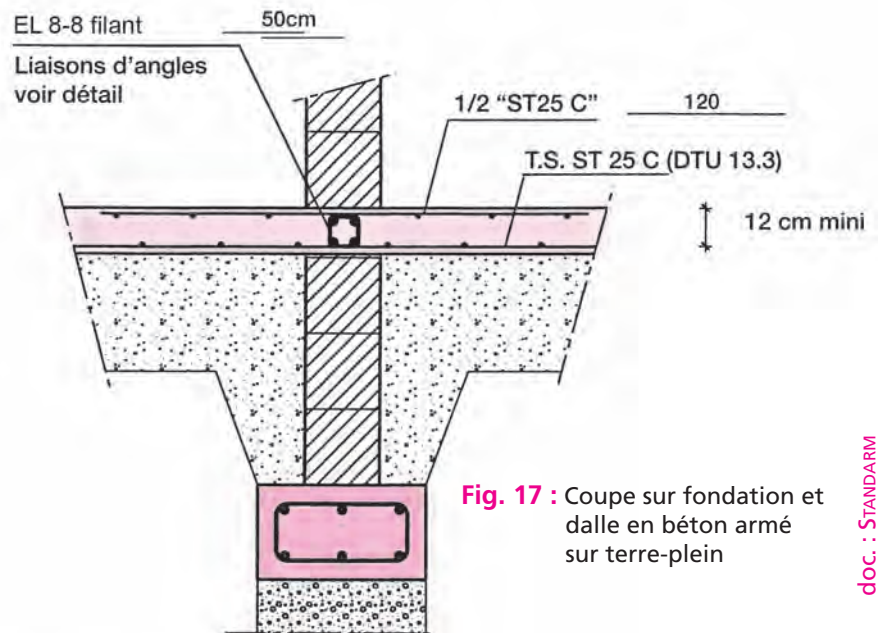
Coupe sur fondation et dalle en béton armé sur terre-plein
